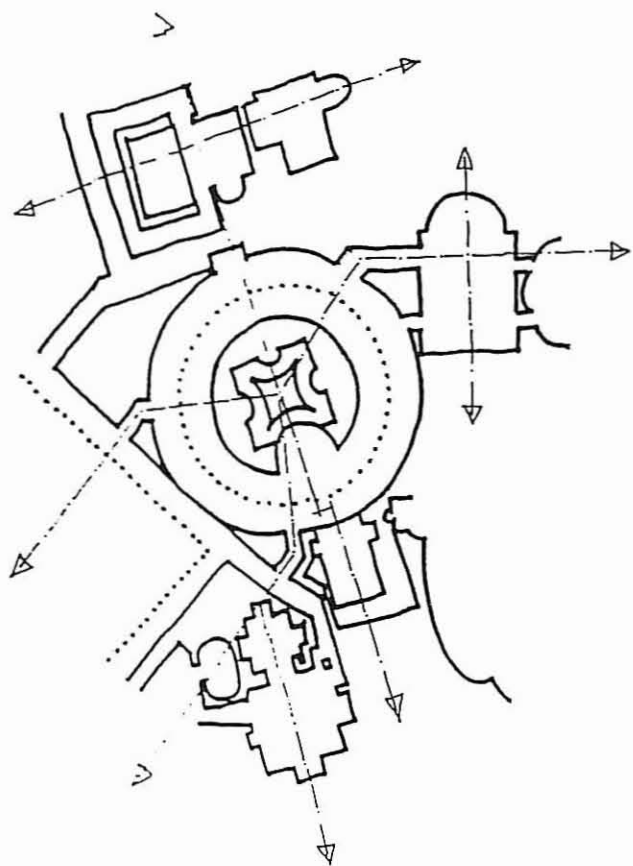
VI Plan du Théâtre d'Eau de la Villa d'Hadrien.
